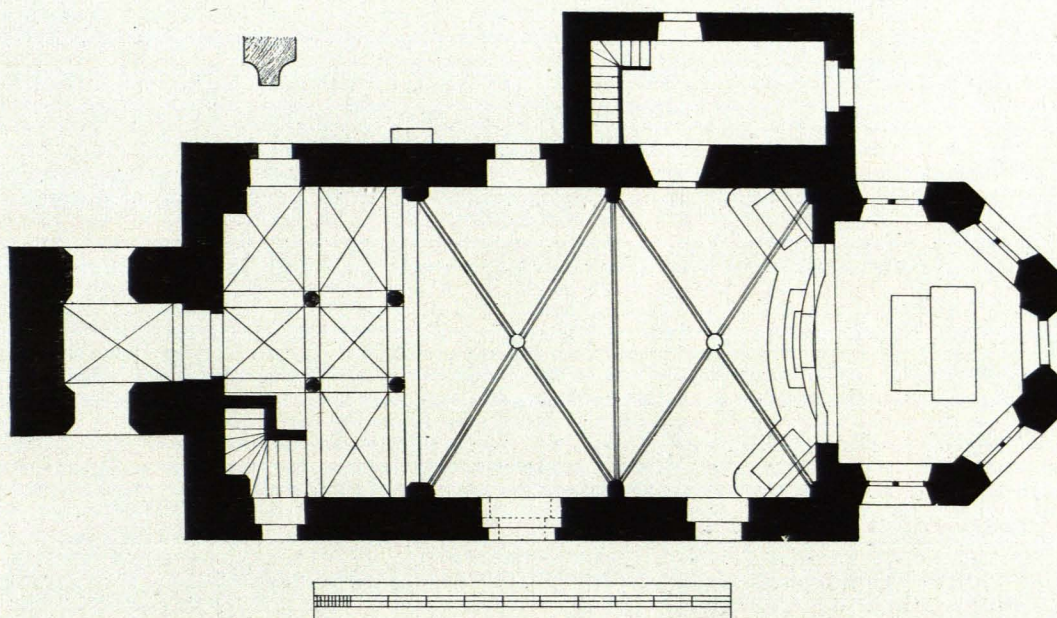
St. Leonhard. Filialkirche, Grundriß 1:200 (S. 282)
